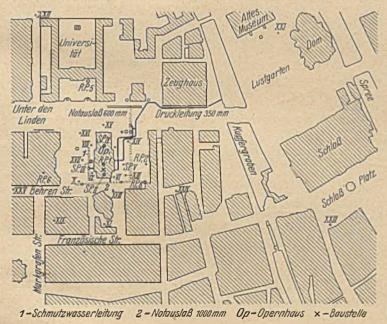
Lageplan der Umgebung der Baustelle mit Darstellung der Einrichtungen zur Beseitigung der gepumpten Wassermenge.
